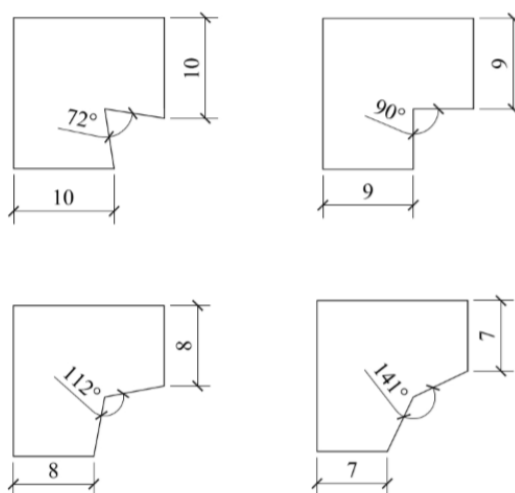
Layouts em planta da escavação (Szepesházi, et al. 2016)
